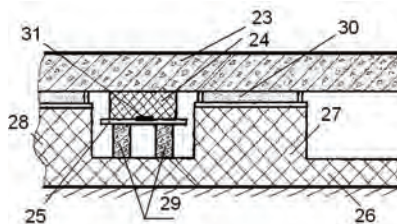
Схема виброизоляции железобетонной плиты в основании здания.
